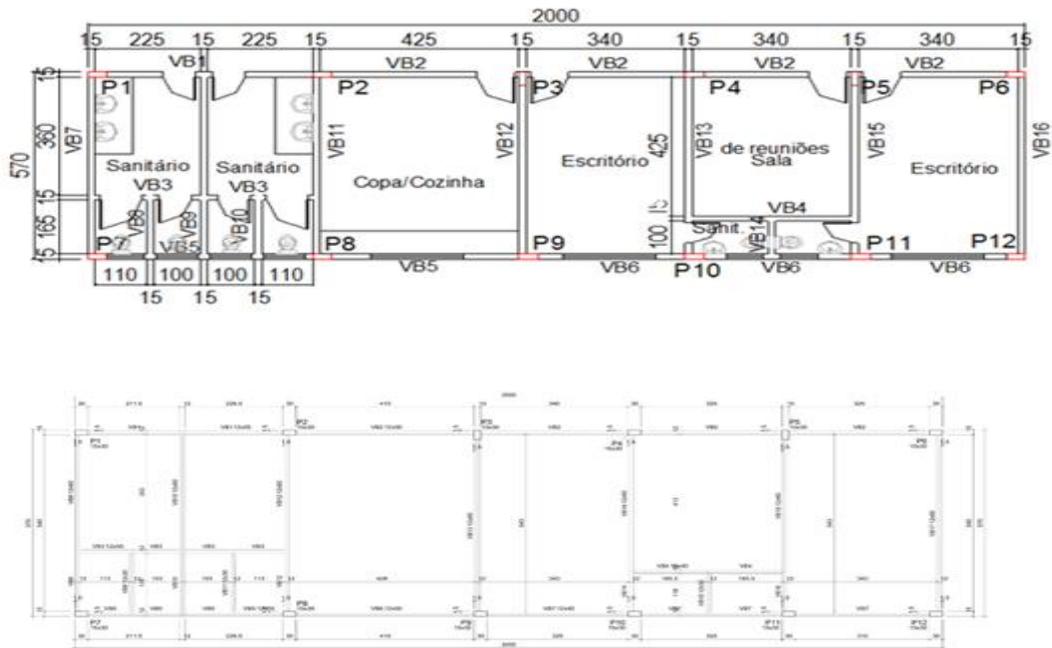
Estudo preliminar: fôrmas (med. em cm) Fonte: elaborada pelo (autor).
